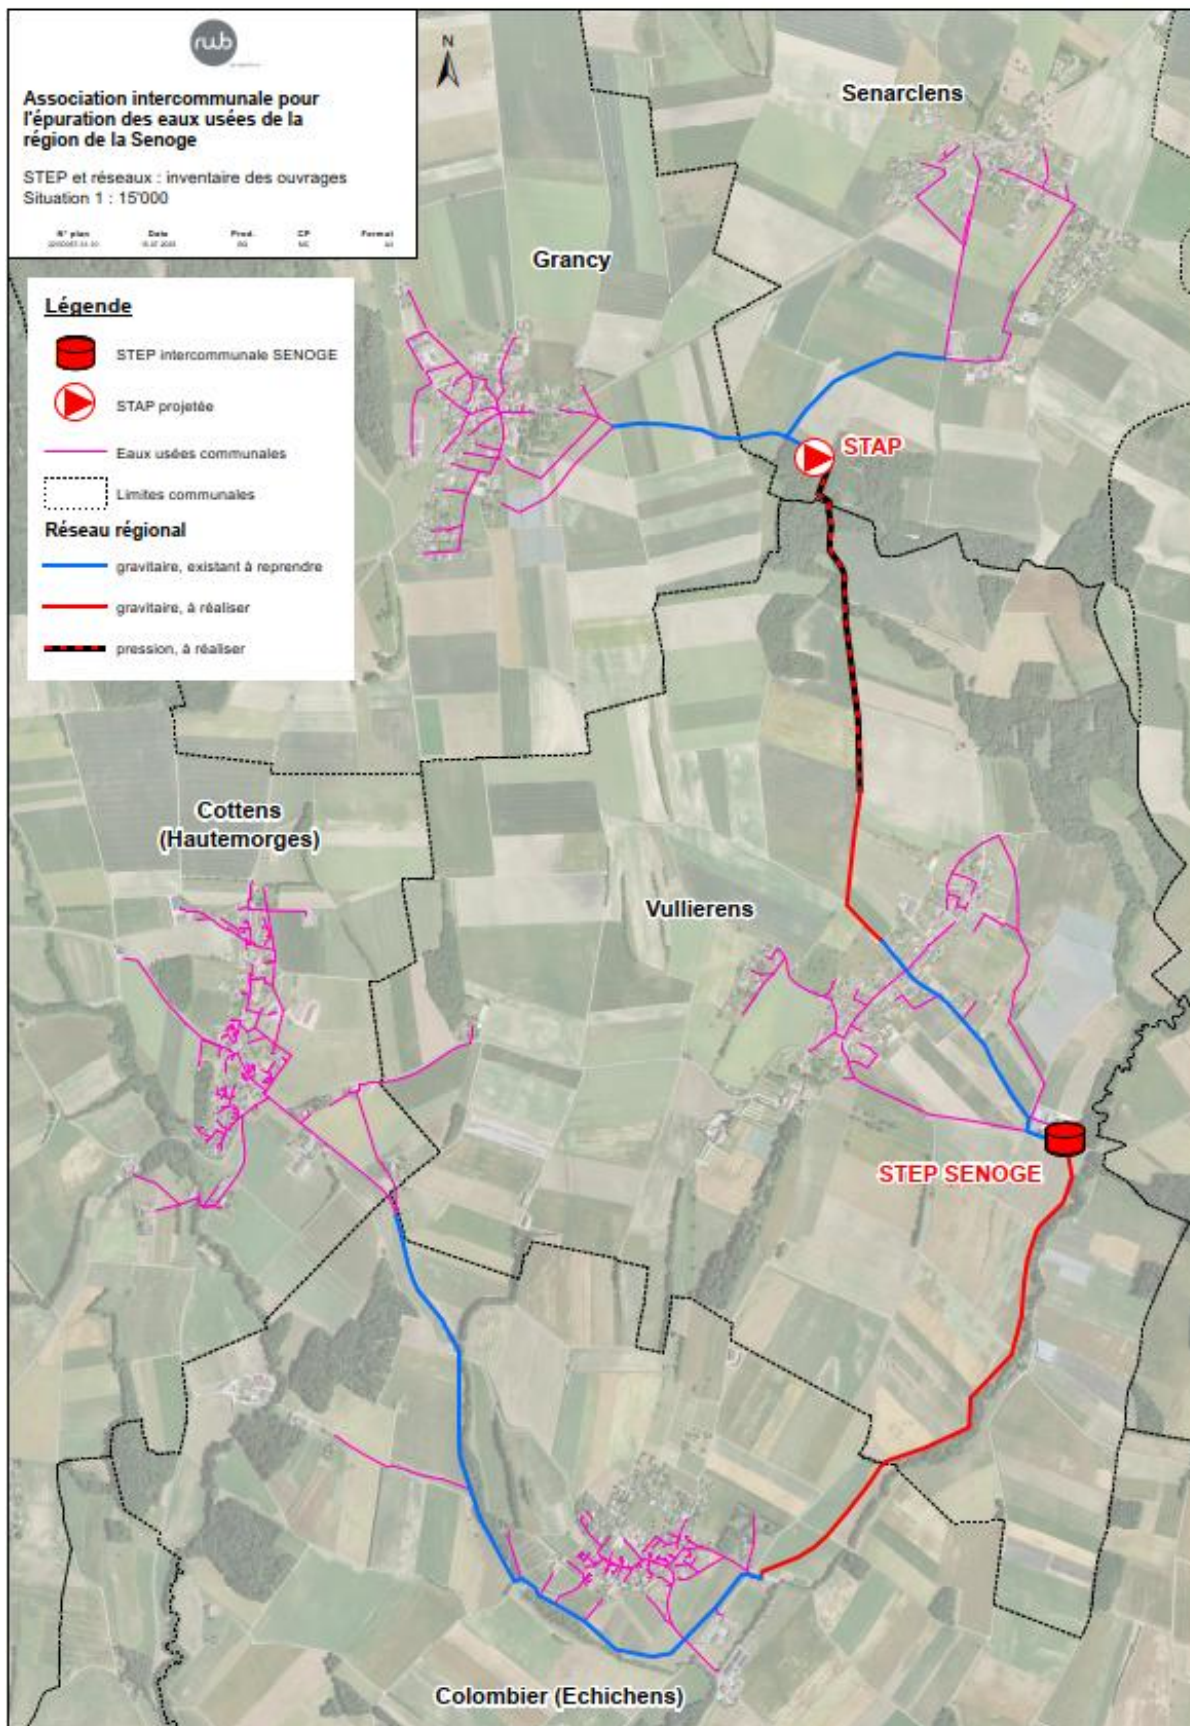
Plan de situation - Inventaire des ouvrages de la STEP Senoге (pas à l'échelle)
